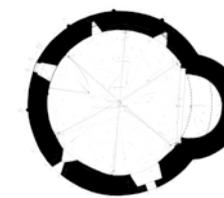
Grundriss BDA Planarchiv Wien. M 1:400.
